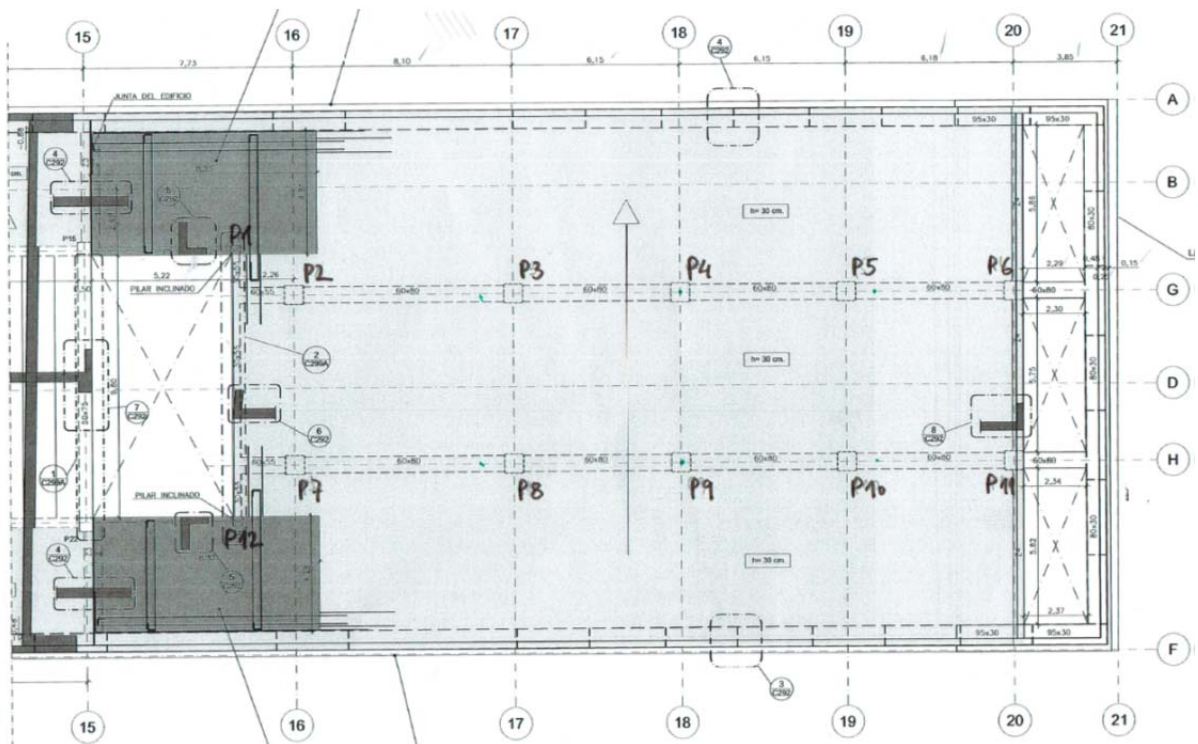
Geometría de estructura del techo de sótano-1 bajo el Pabellón, (Zona B).
